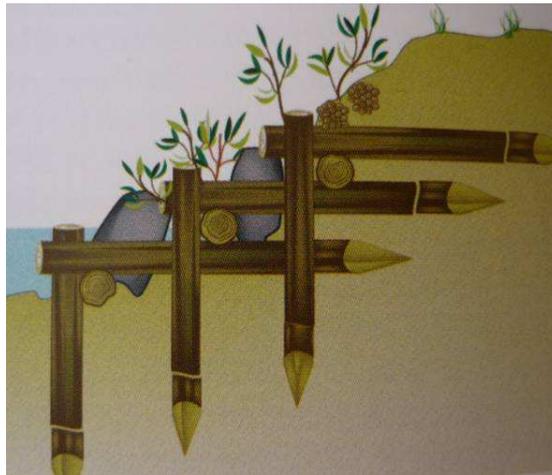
Estructuras combinadas con piedras en la base del talud, y un entramado de troncos verticales y horizontales sobre los que se colocan las estacas del sauce, apropiadas para taludes de elevada pendiente.
